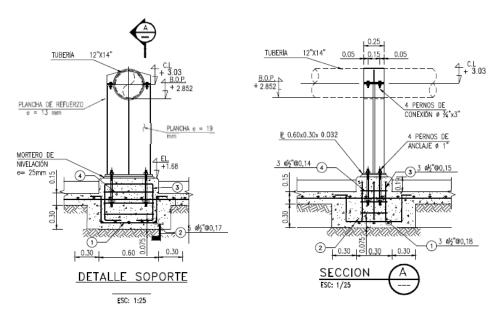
Detalle típico de un soporte metálico de tubería mixta
